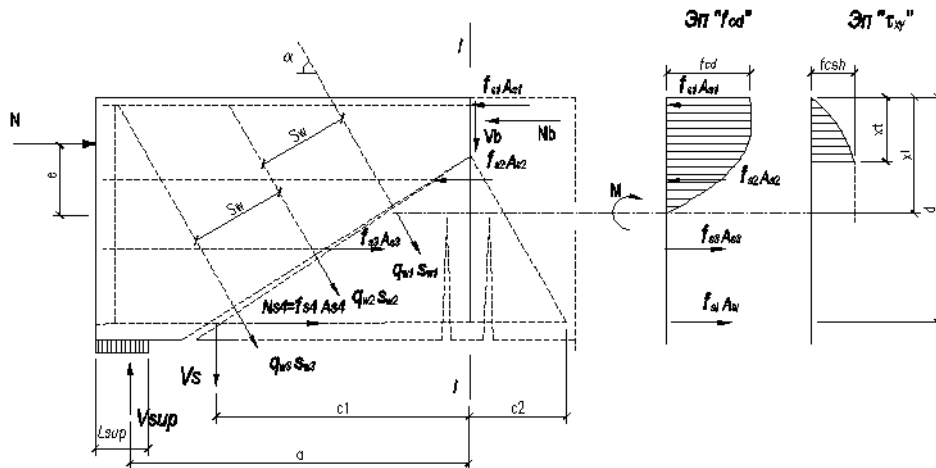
Розрахункова схема до розрахунку опору залізобетонних колон кругового перерізу за перерізом, похилим до поздовжньої осі елемента.
